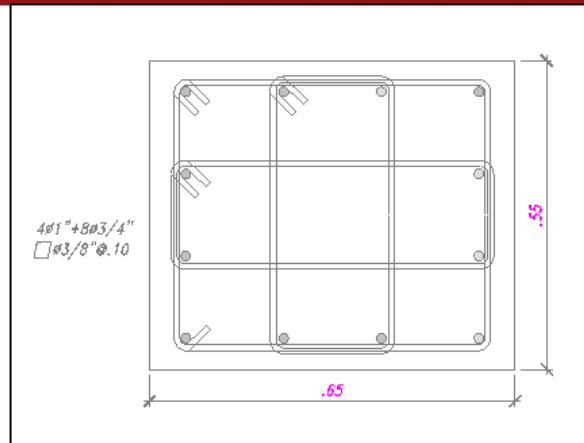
Fierros y estribos en una sección típica del pedestal de concreto
